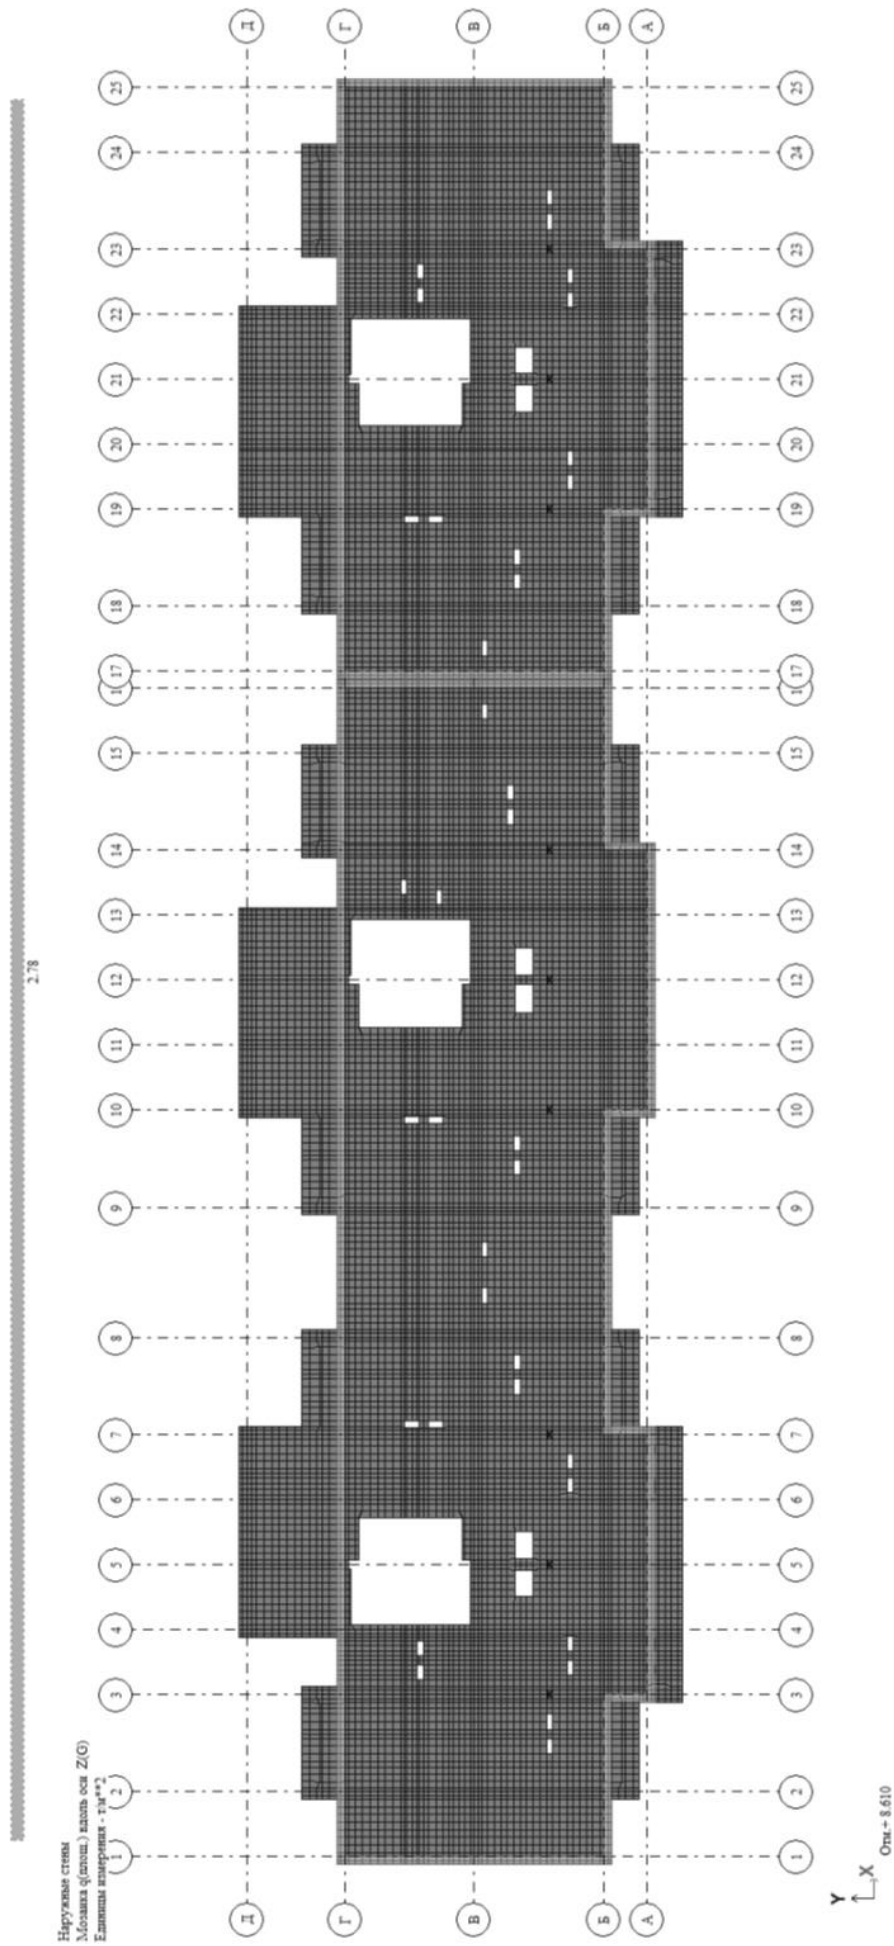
Мозаика вертикальных нагрузок на перекрытие типового этажа от веса наружных стен (загружение 4)
